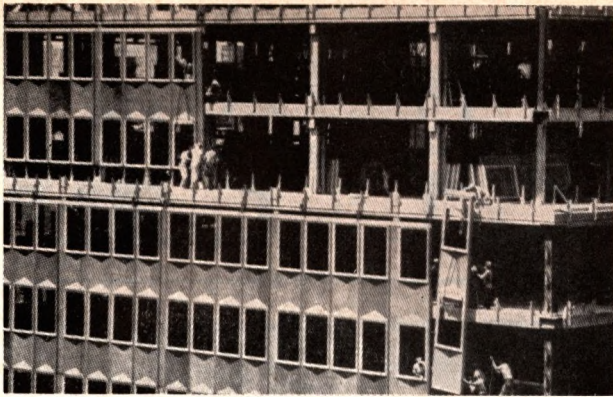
Gedeelte van de gordijngewel van het gebouw 460 Park Avenue te New York. De gevelelementen worden van binnenuit geplaatst.
